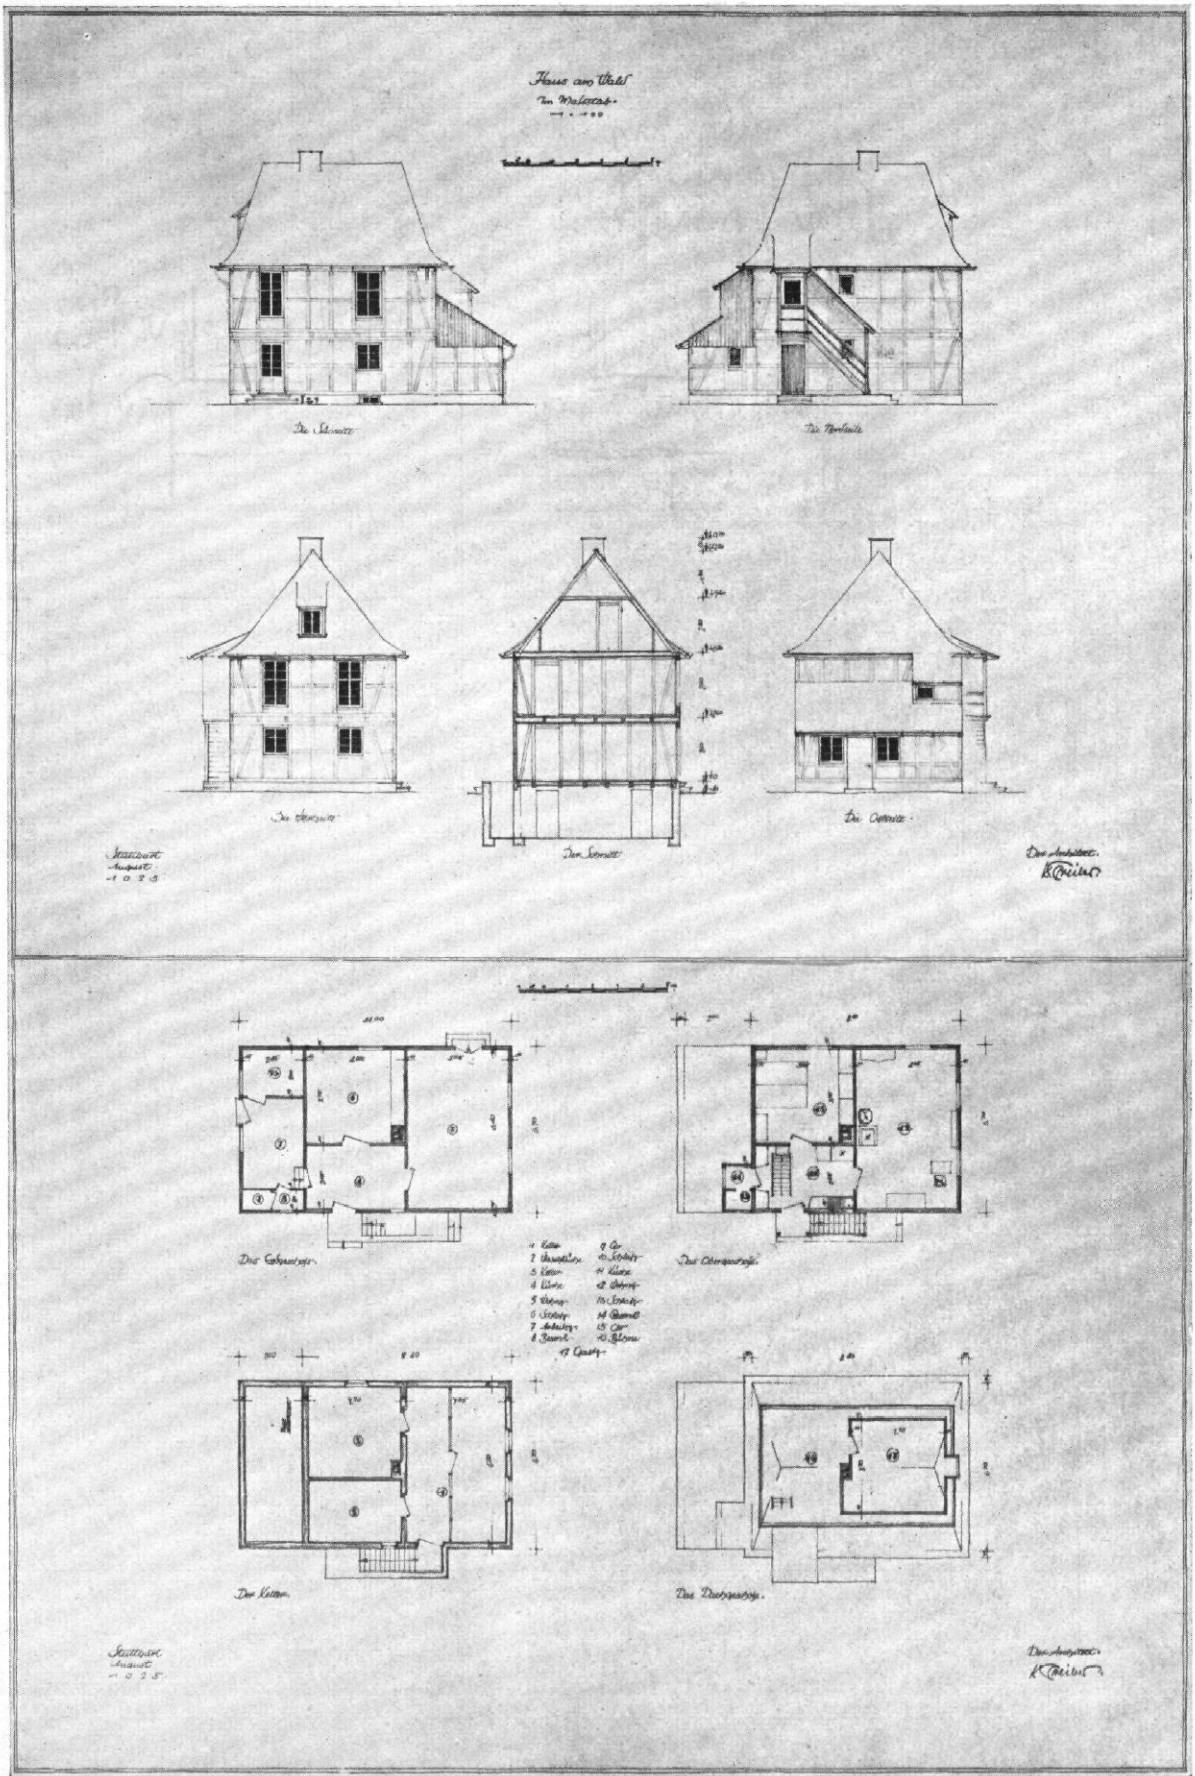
| Ansichten und Grundrisse eines Wohnhauses in Böblingen | Architekt: Karl Treiber, Warmbrunn
